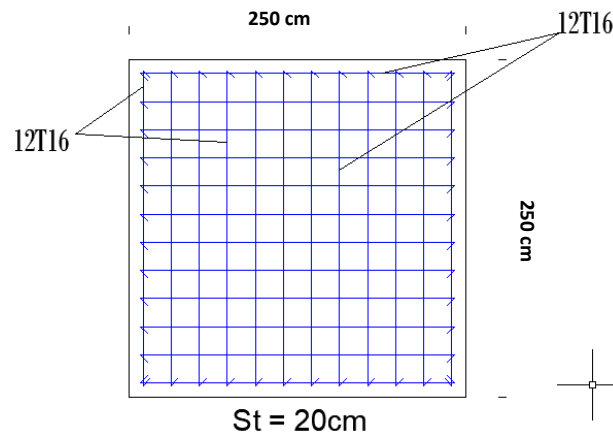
Schéma de ferrailage de Semelle isolées (240x240x55) cm.
